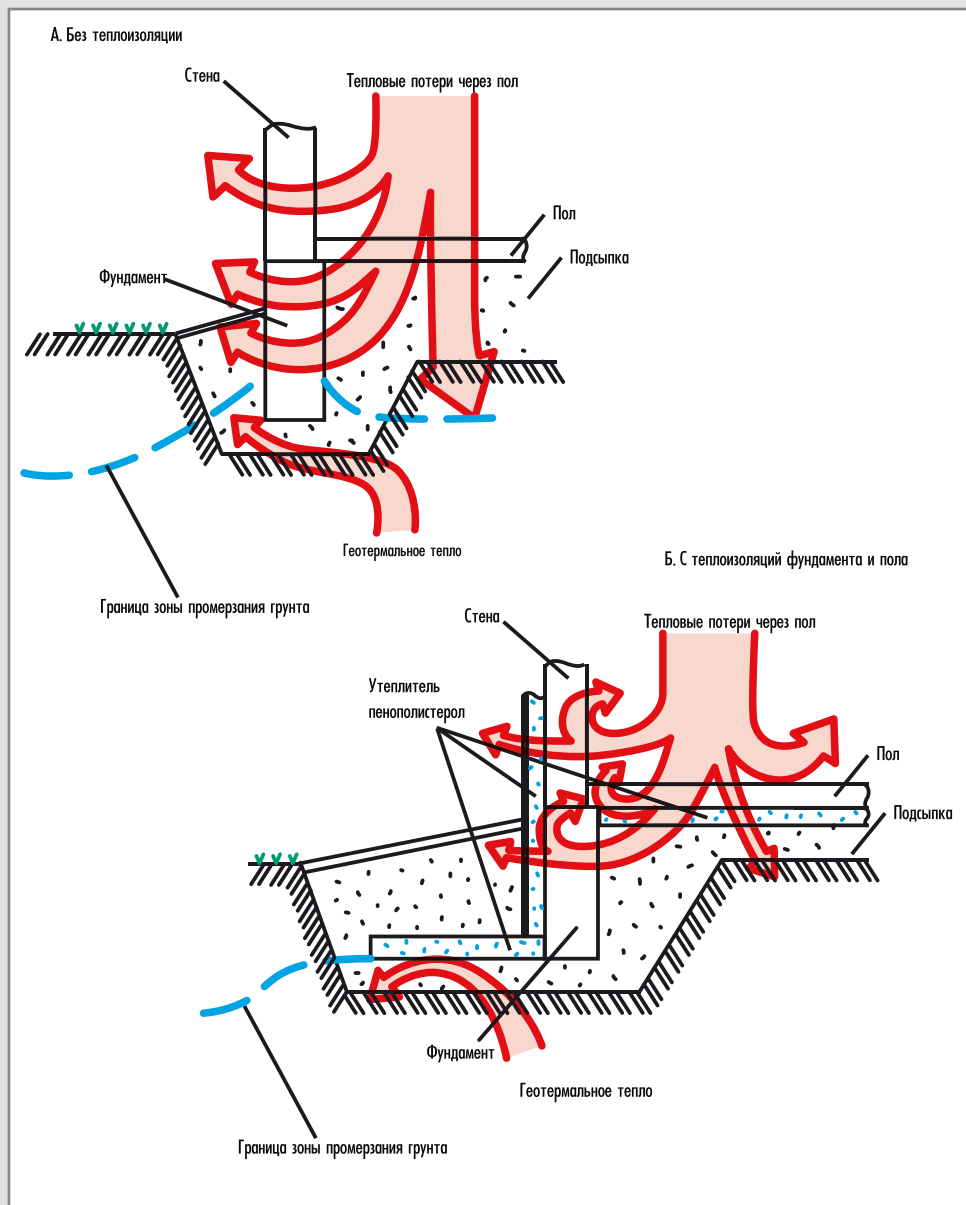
а. Тепловые потери через пол и фундамент малоэтажных зданий
